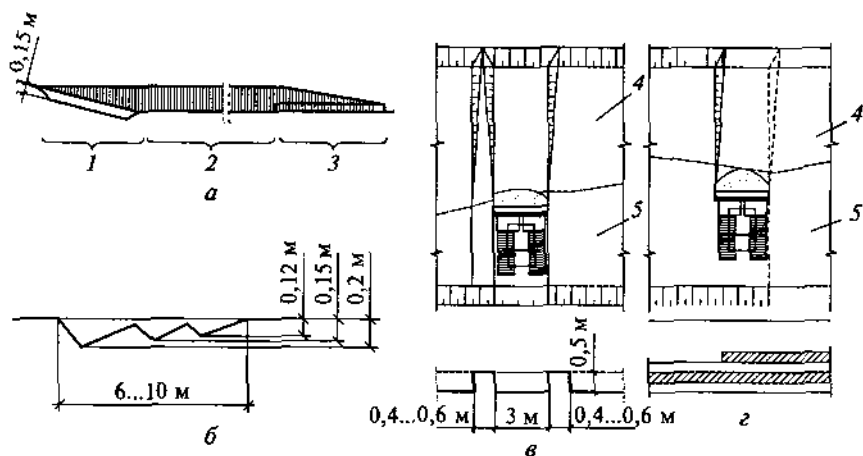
Схемы резания и перемещения грунта бульдозером:
